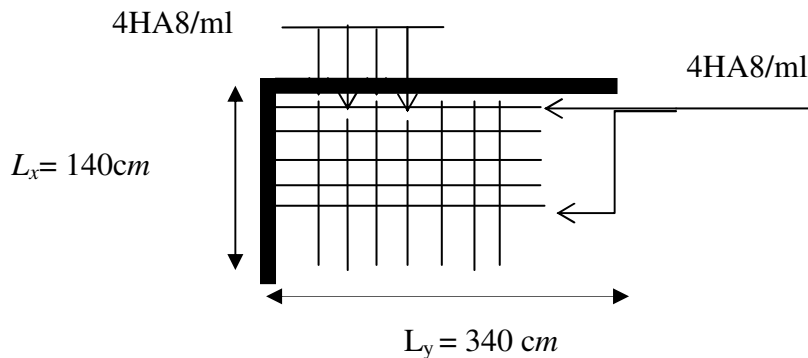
Schéma de ferrailage de la dalle pleine type2
